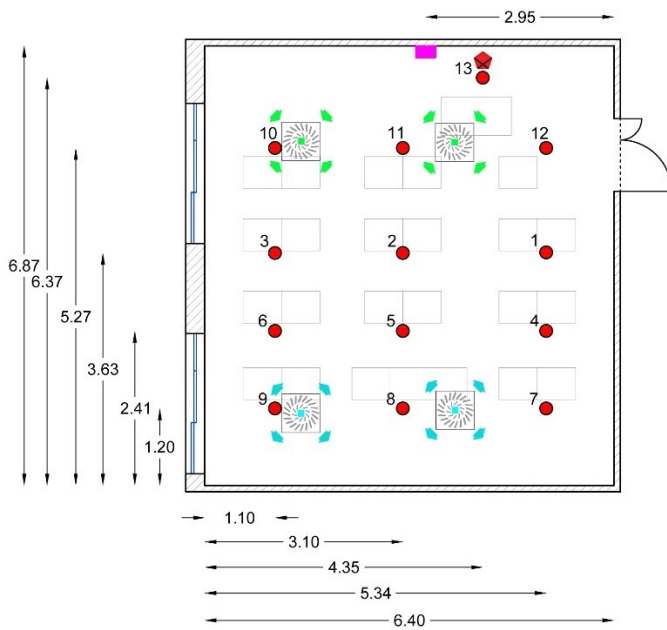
Planimetria con individuazione punti di presa dei sensori nell'aula di Recanati
